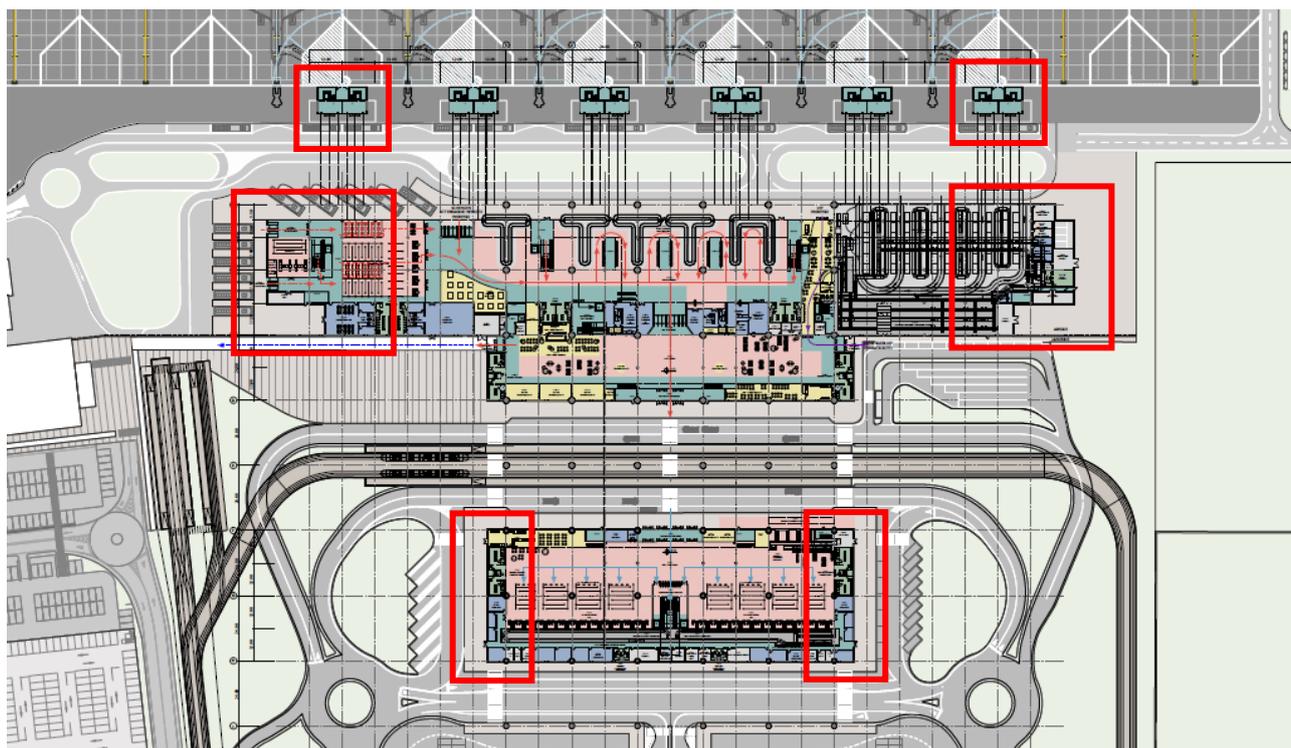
| Planimetria Piano Terra Terminal Anno 2035
